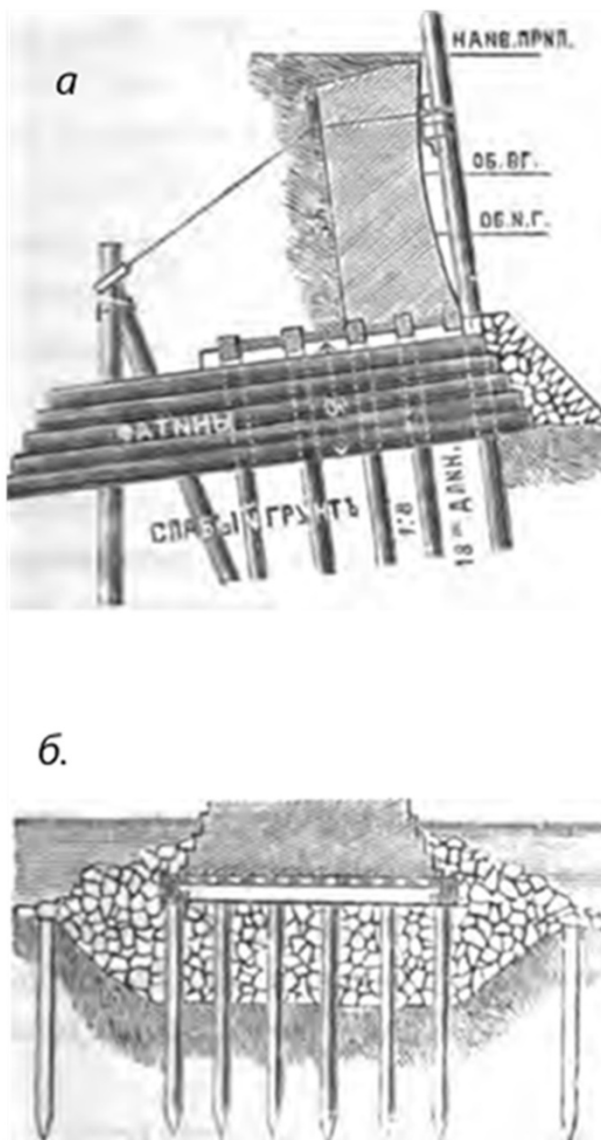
Конструктивные решения свайных фундаментов с высоким ростверком [23]
